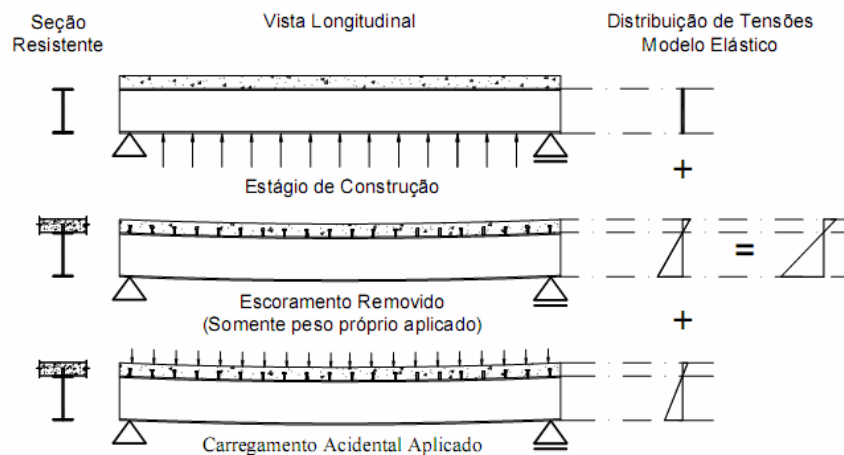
Vigas mistas escoradas – FABRIZZI (2007)
